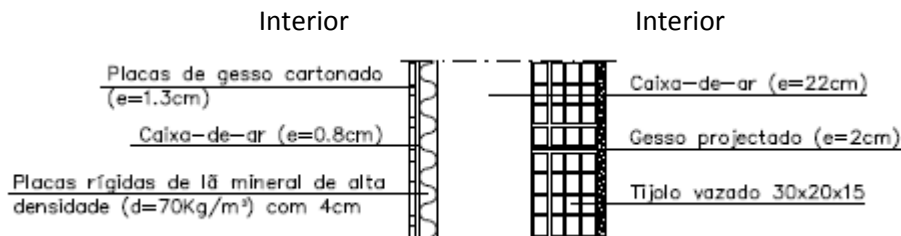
Pormenor construtivo da parede Pi5 [17]
